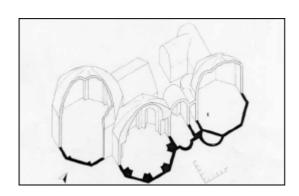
Ricostruzione grafica della planimetria dell'edificio
